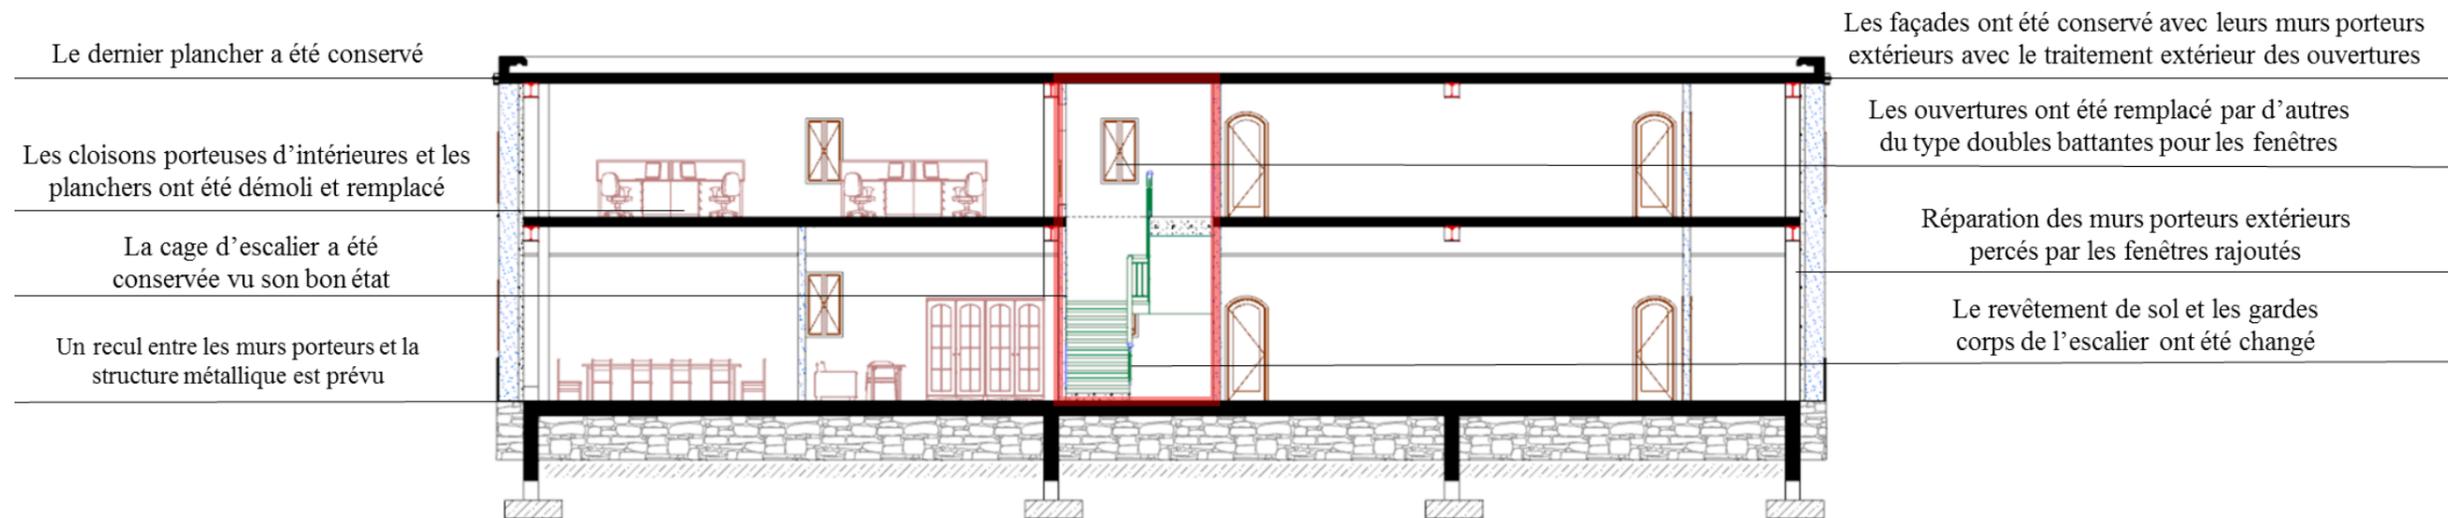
Coupe montrant les différentes actions d'intervention sur l'entité B
